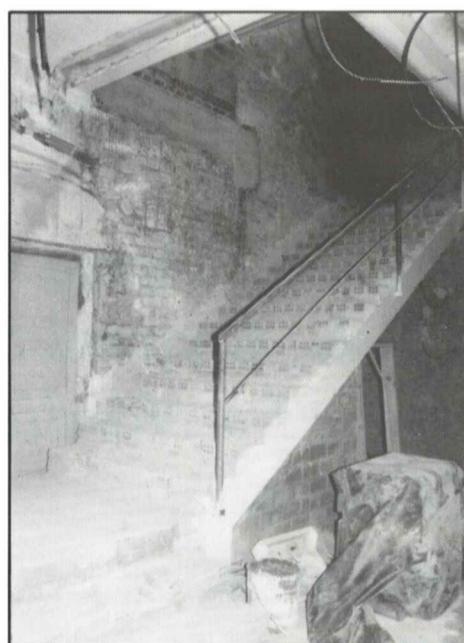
Adaptación de la escalera de subida al entresuelo.
